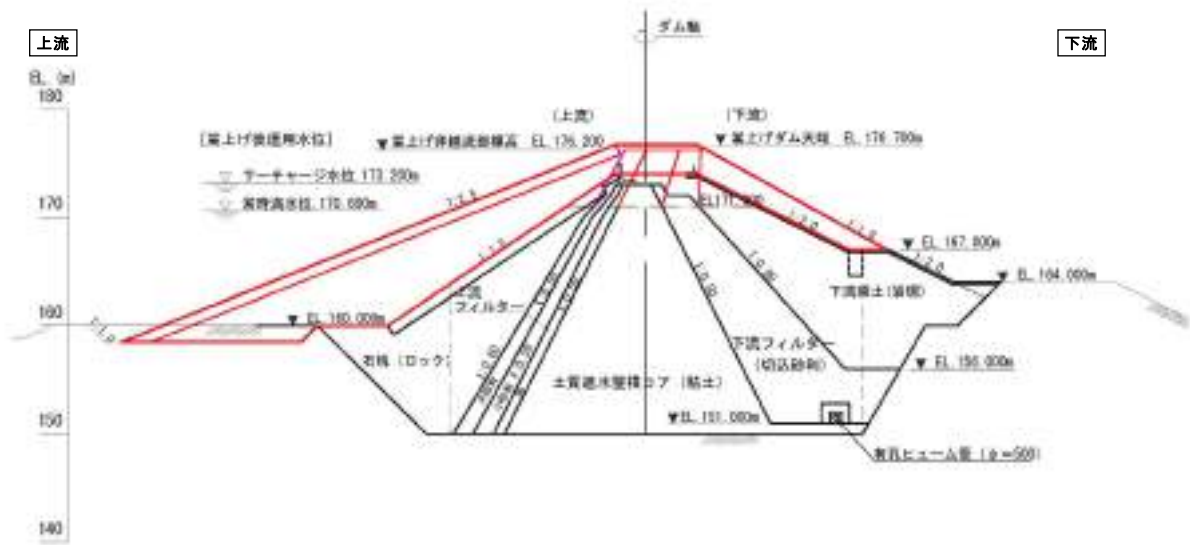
ダム堤体の標準断面図（右岸フィルダム部）
